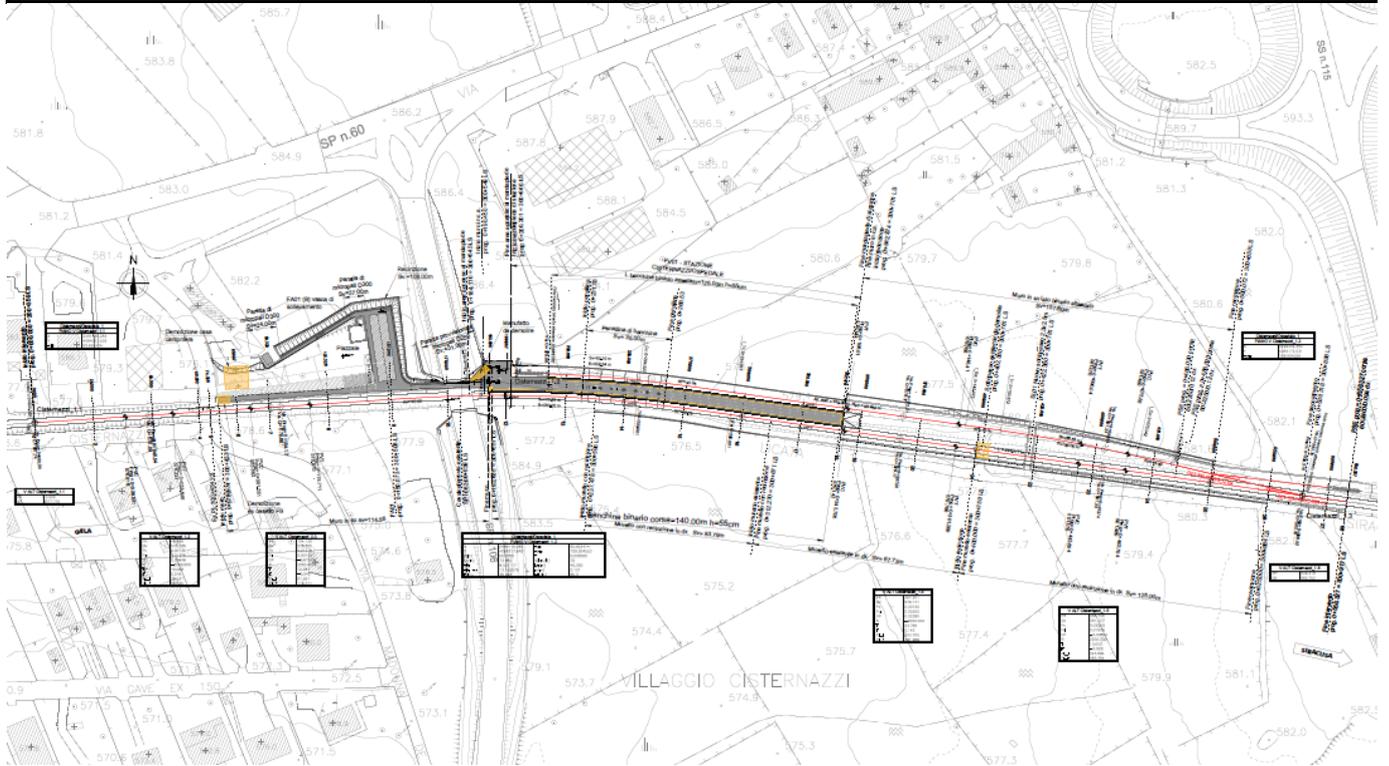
Planimetria di progetto nuova stazione Cisternazzi/Ospedale
